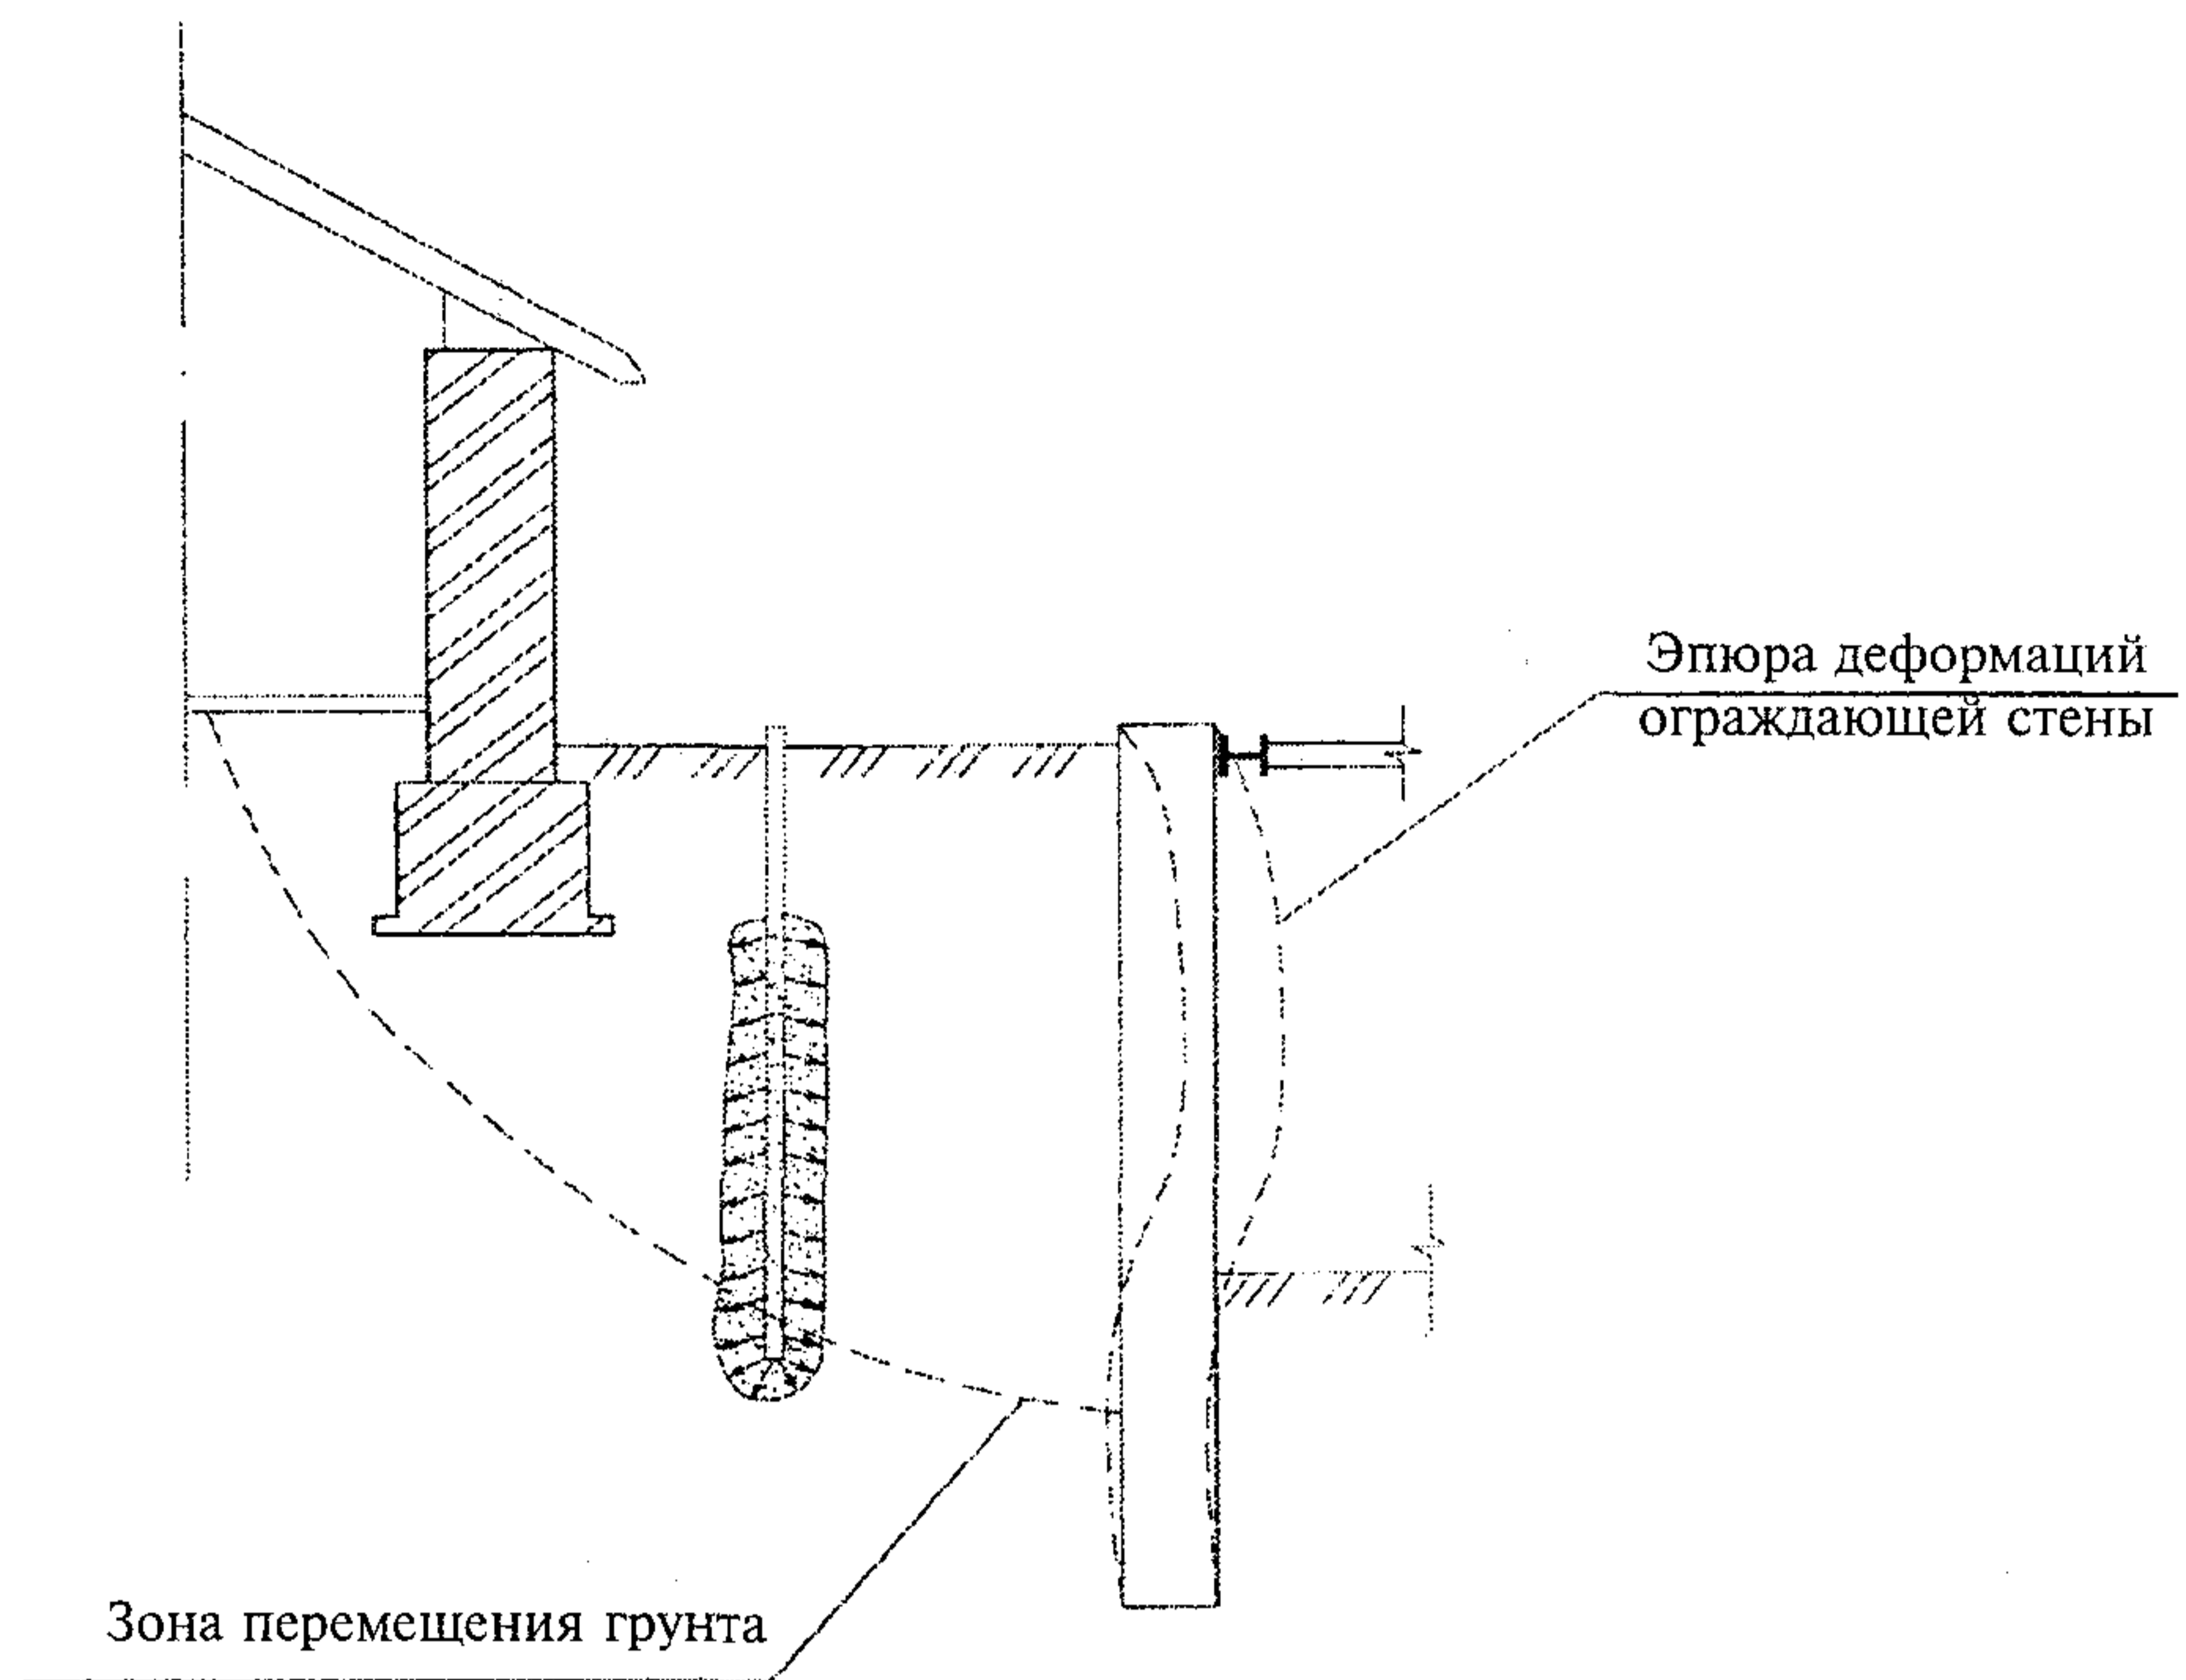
Защита фундамента здания при устройстве котлована
